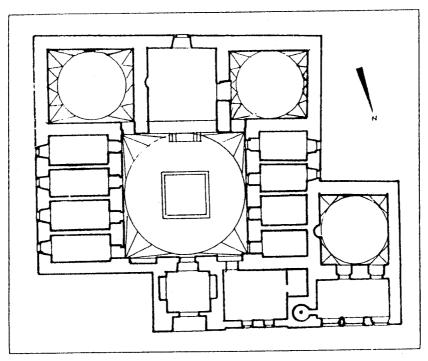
مسقط أفقي لمسجد شاه چهان في تهتا (باكستان) ١٠٥٤هـ/١٦٤٤م.
